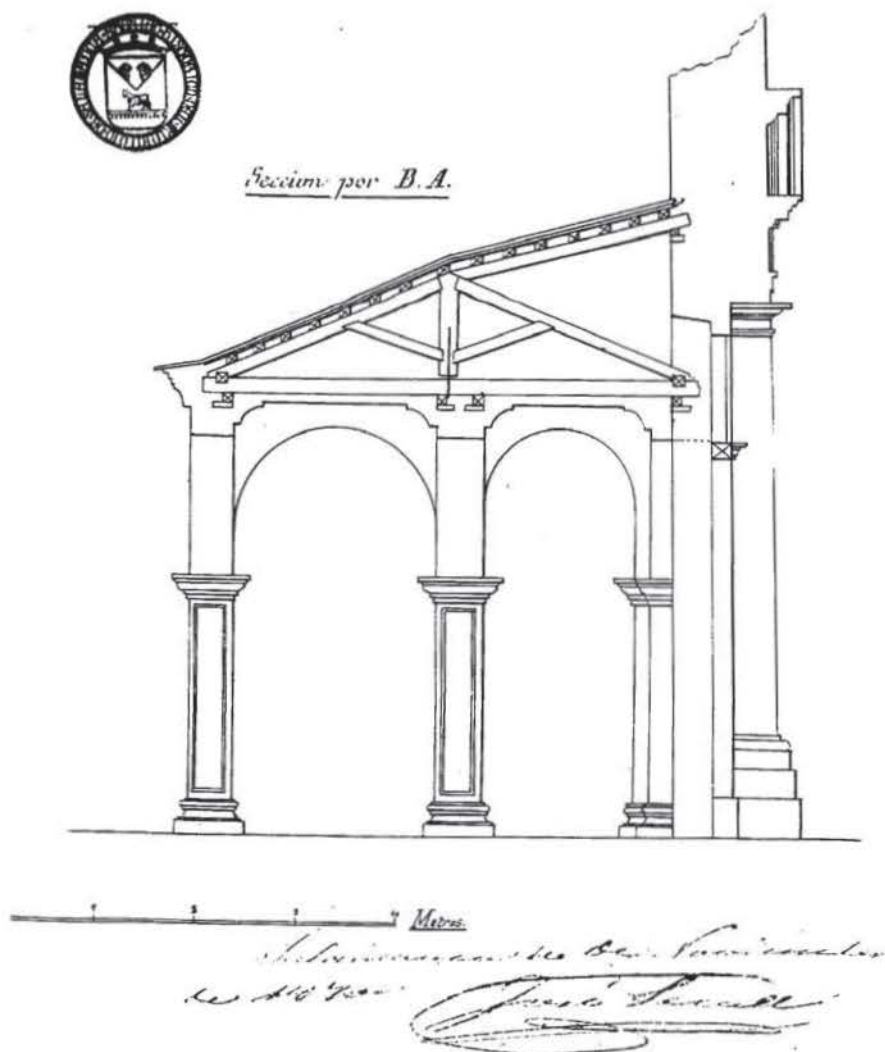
Proyecto de pórtico interior de la fachada principal (Secall, 1870)
